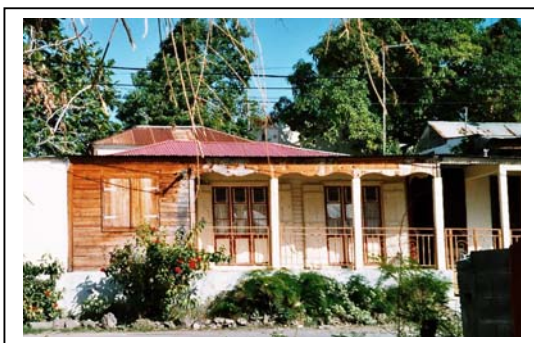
Extension en dur d'une case en tôles à Bonan Vassor en Guadeloupe (février 2004)
